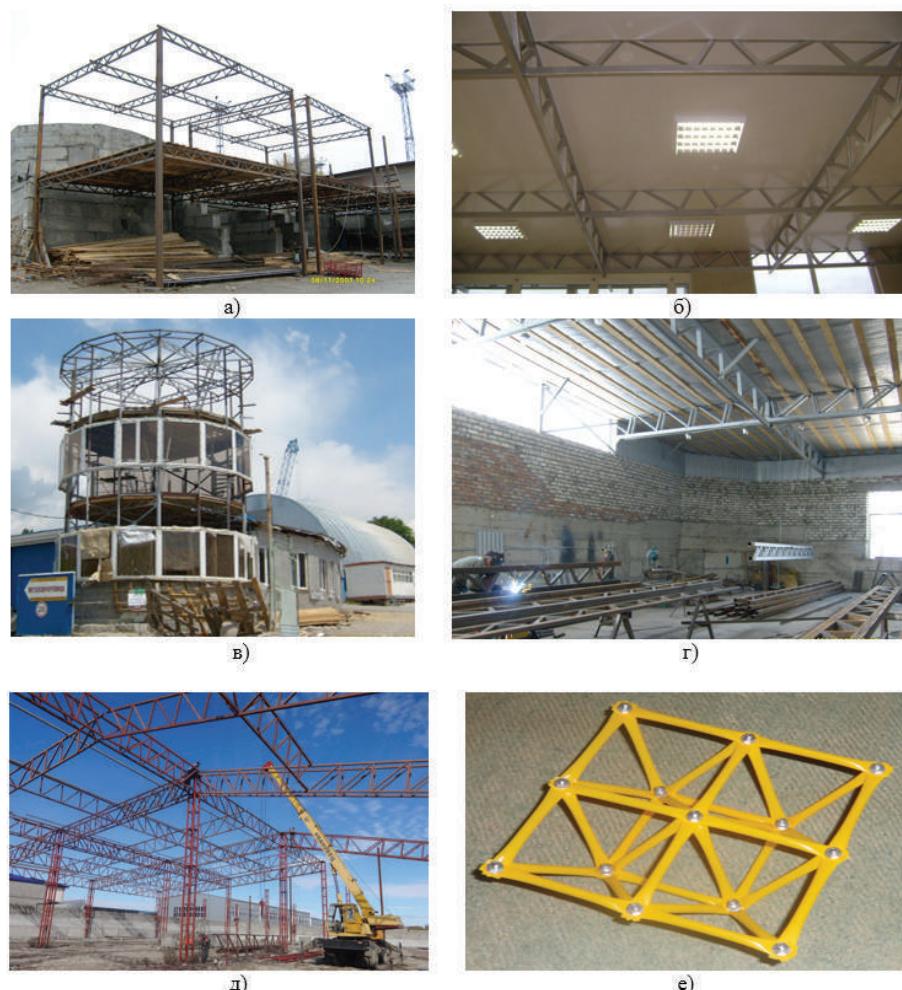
Снимки двухэтажных модулей (а), блока перекрытия в интерьере офисного здания (б), трехэтажного модуля (в), цеха по изготовлению перекрестных ферм (г), монтажа модулей покрытия (д) и фрагмента конструкции с использованием пространственного решетчатого узла перекрестных ферм типа «Новокисловодск» (е)
